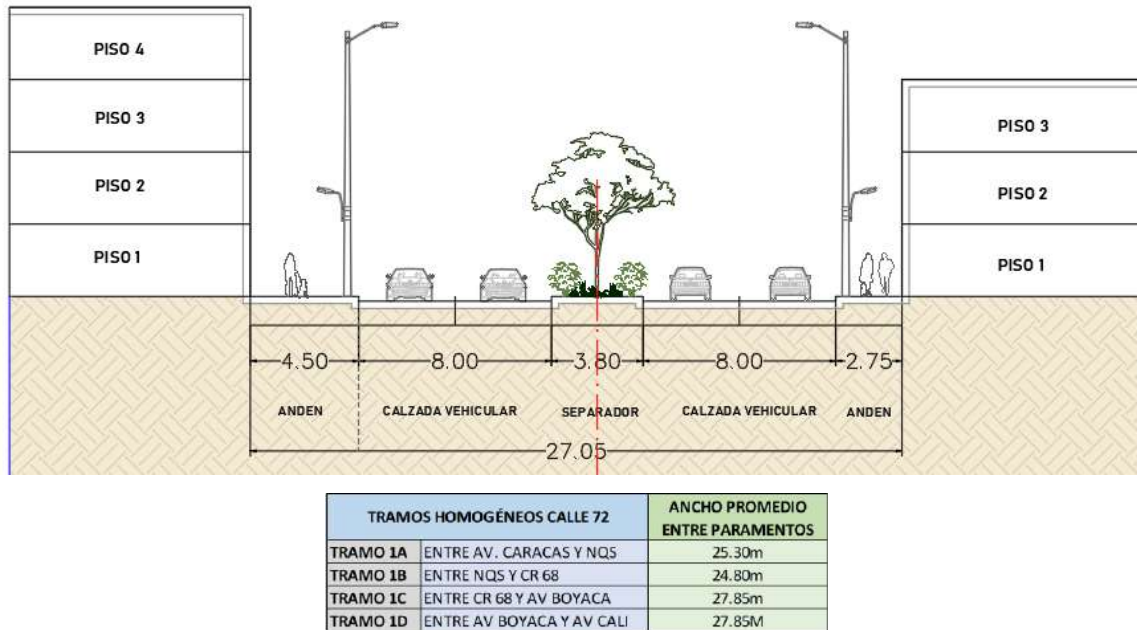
Sección Vial V2 con sistema metro elevado o subterráneo - POT Bogotá.
